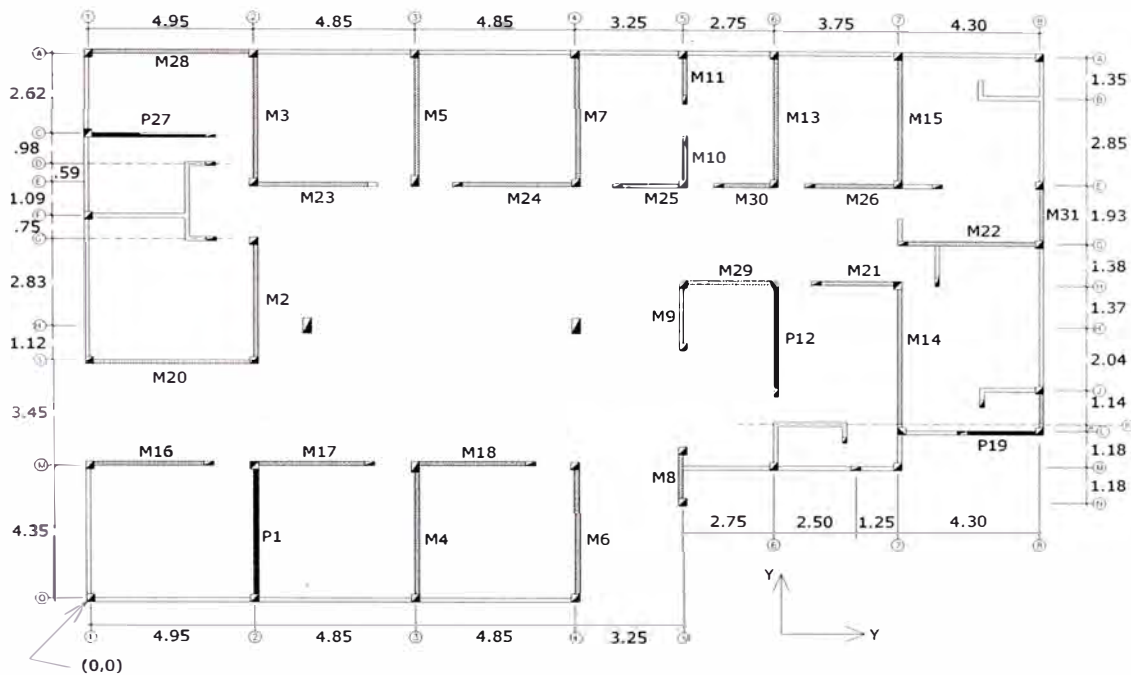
Distribución Estructural de columnas y, muros y placas según el análisis estructural y el diseño de muros.
